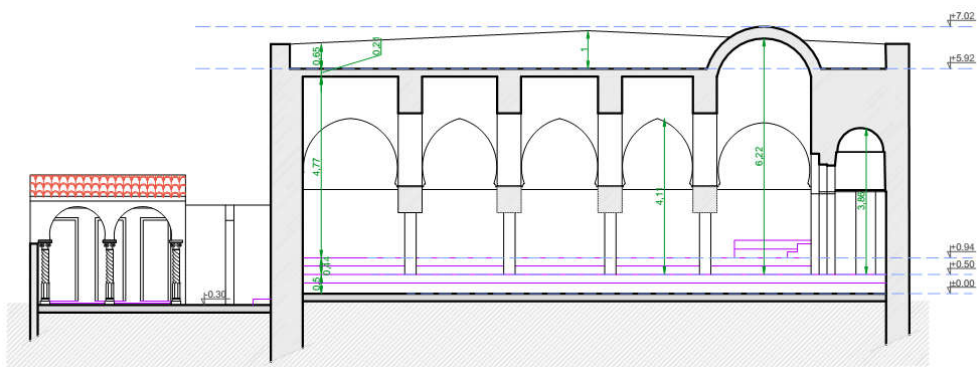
Plan de coupe de la mosquée Sidi Maïza.
